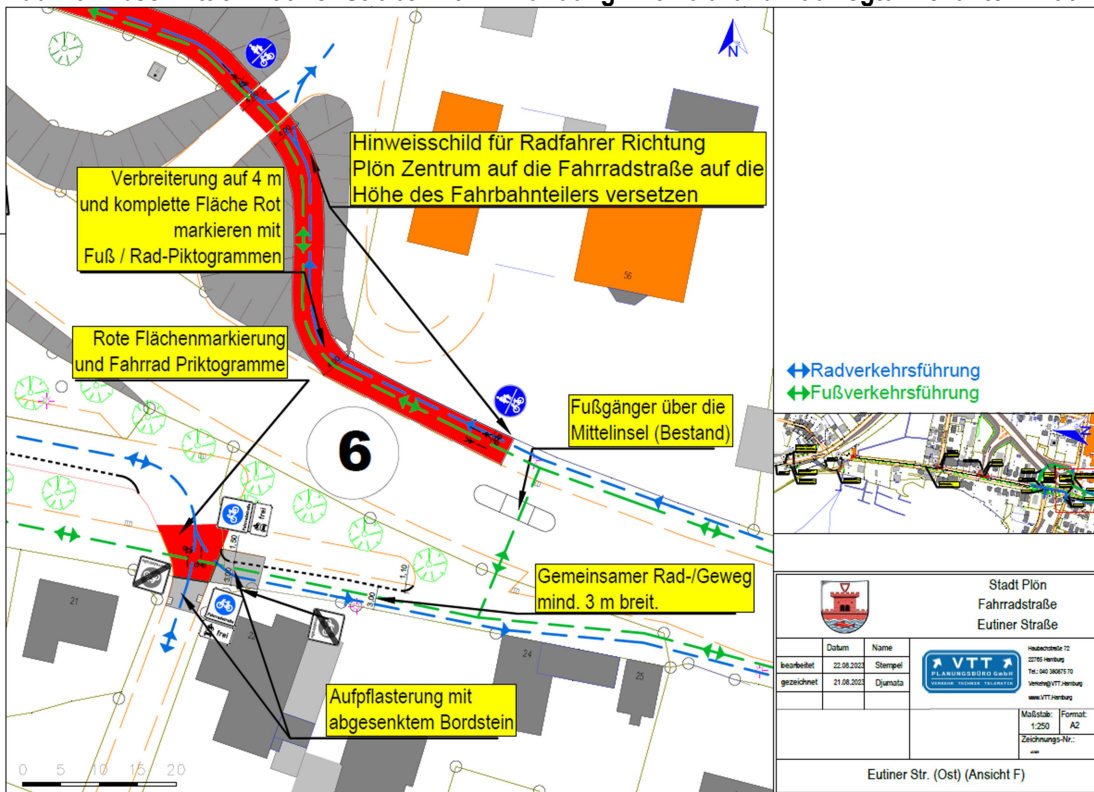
Abschnitt 6 - Eutiner Straße mit Einmündung Scharweg und Übergang B 76 / Rautenbergstraße
